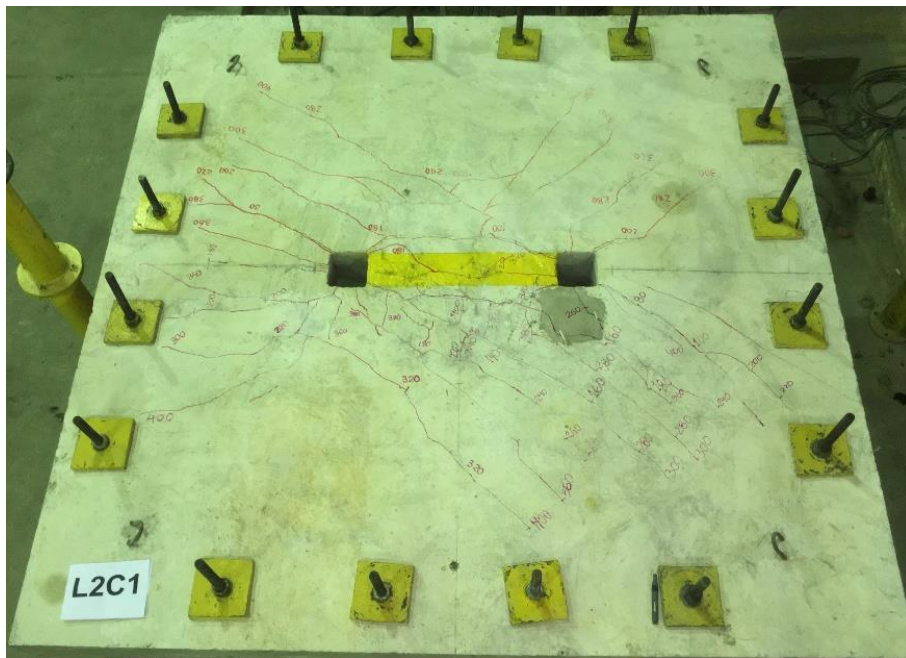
Padrão de fissuração da laje L2C1
